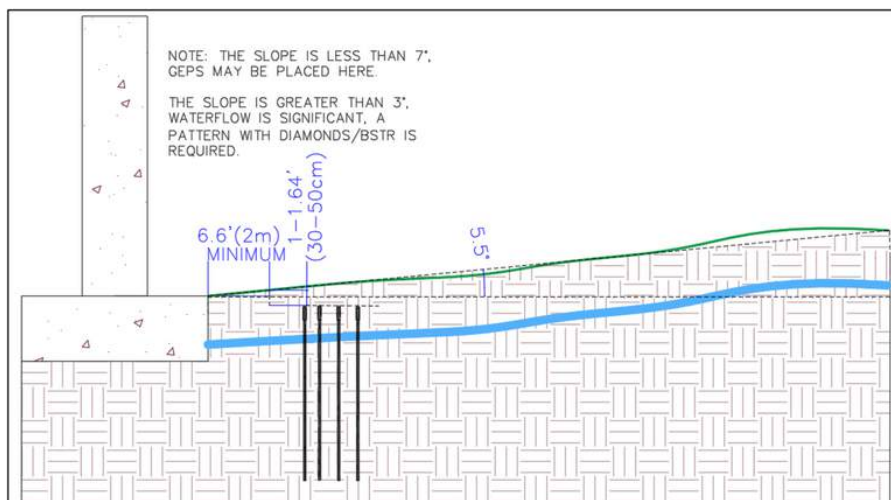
Przekrój poprzeczny GEPS zainstalowanego pod powierzchnią w pobliżu fundamentu.
